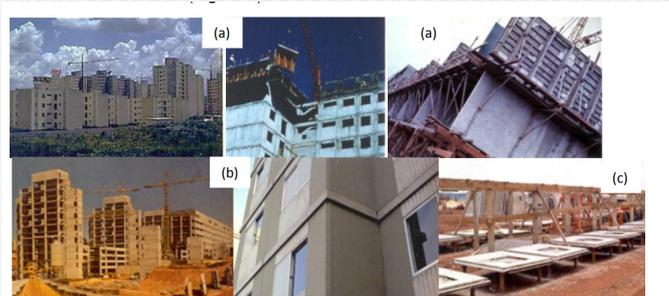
Conjuntos habitacionais de meados da década de 80 em São Paulo (a) Sistema de paredes maciças de concreto moldadas com fôrmas de aço - sistema *Outnord*; (b) edifício com painéis e lajes pré-fabricados de concreto (c) produção de painéis pré-fabricados de concreto em usina, para edifícios de múltiplos pavimentos (Fonte: Arquivo Mercia Bottura Barros).
